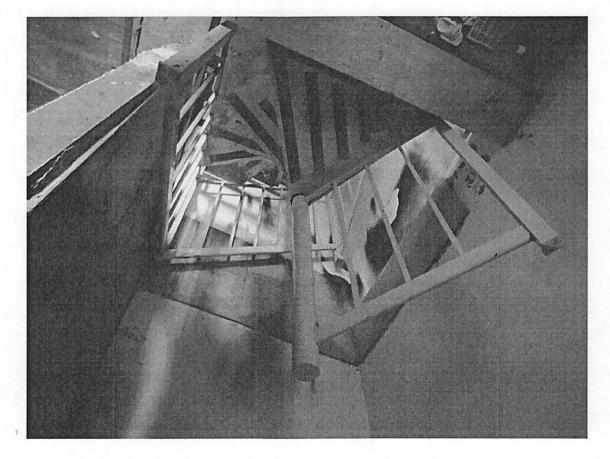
PIANO TERRA (foto n.18)
